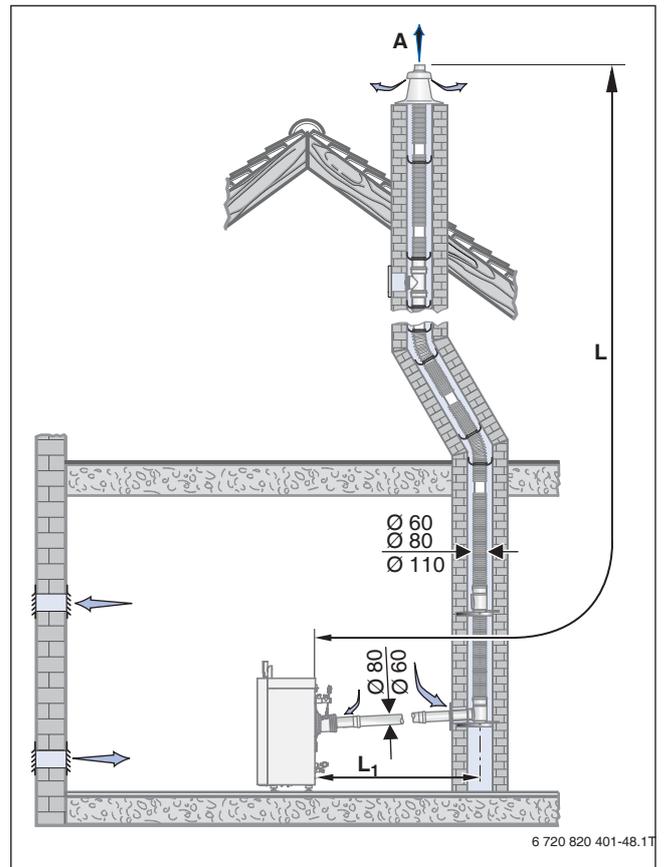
Montagevariante mit dem Bausatz GA + ÜB-Flex
